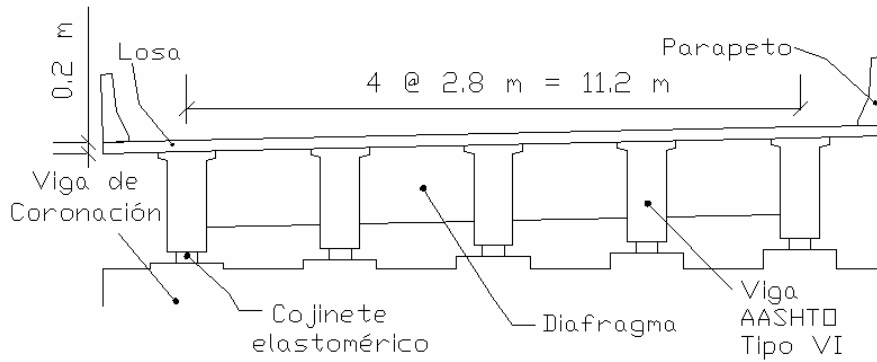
Vista frontal de una sección de la cubierta del puente instrumentado
